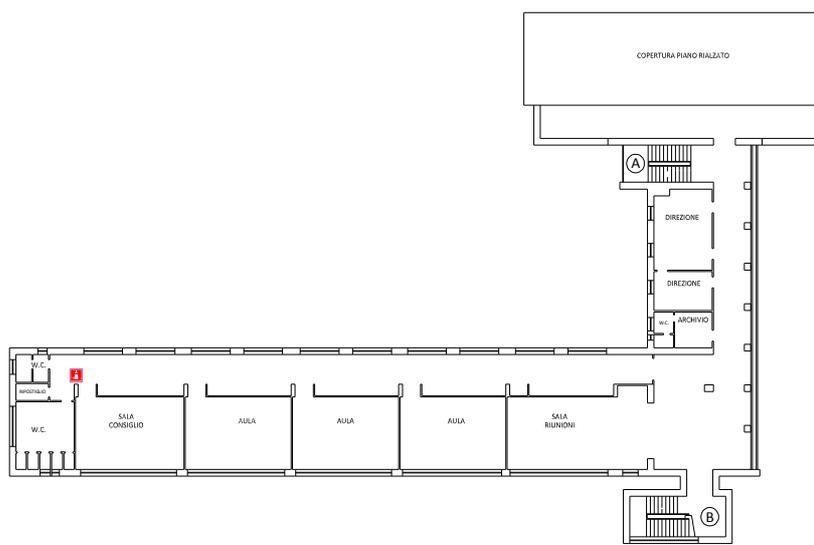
4: Pianta piano primo (blocco aule 1)
